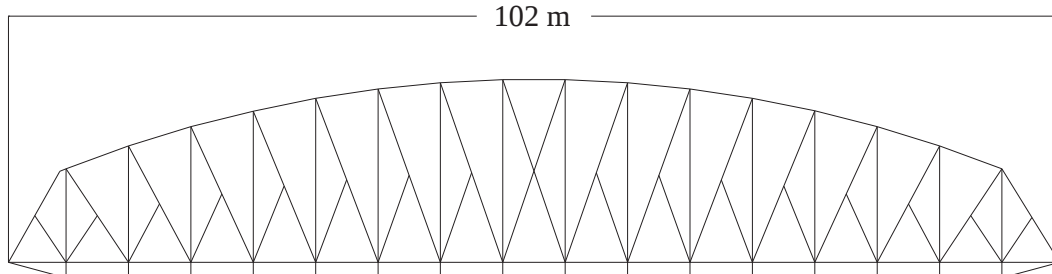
Arco de la armadura metálica tipo Camel back.
